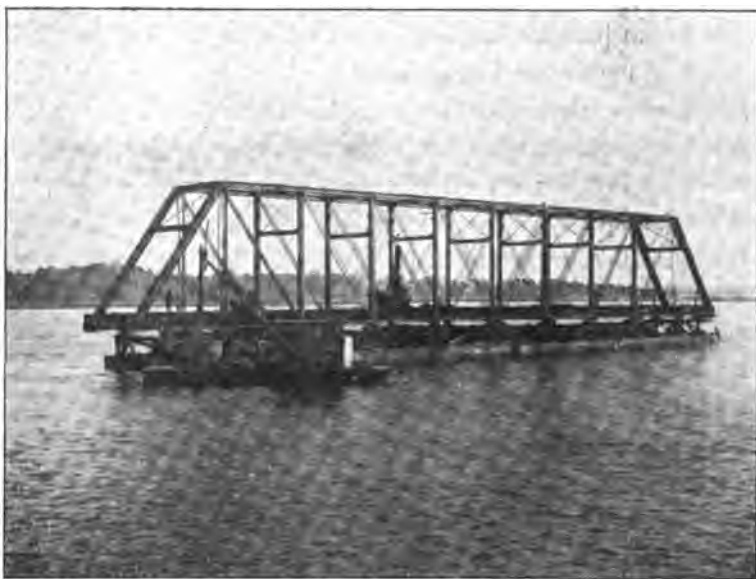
Transport par eau d'une travée de 76^m.30 du Pont de Jacksonville sur le St-John's River. — 31 minutes après le départ (Keystone Bridge Co).
